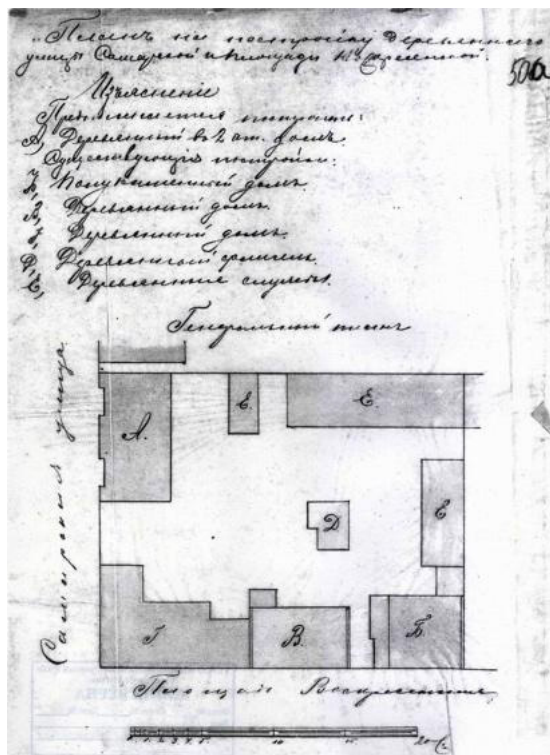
Генеральный план владения М. Д. Маштакова на углу Самарской улицы и Воскресенской площади. Подпись к плану
